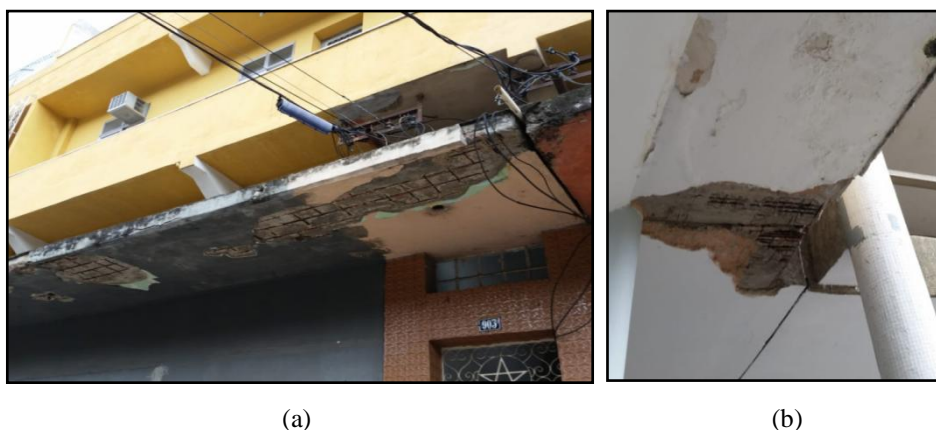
(a) Marquise com corrosão da armadura (b) Laje com corrosão da armadura
